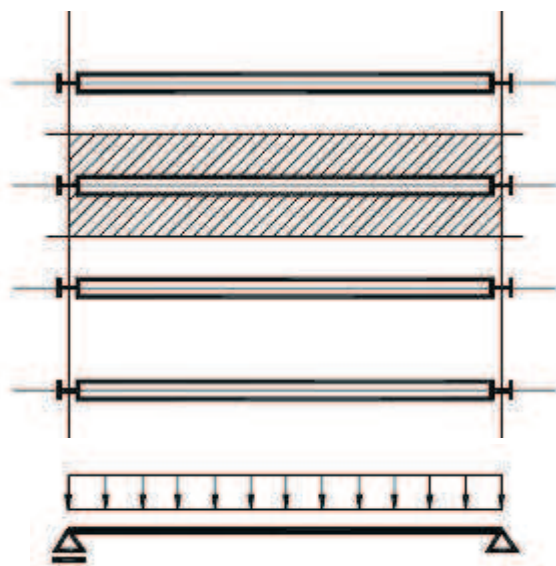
Pianta del solaio con travi in acciaio – semplice appoggio
